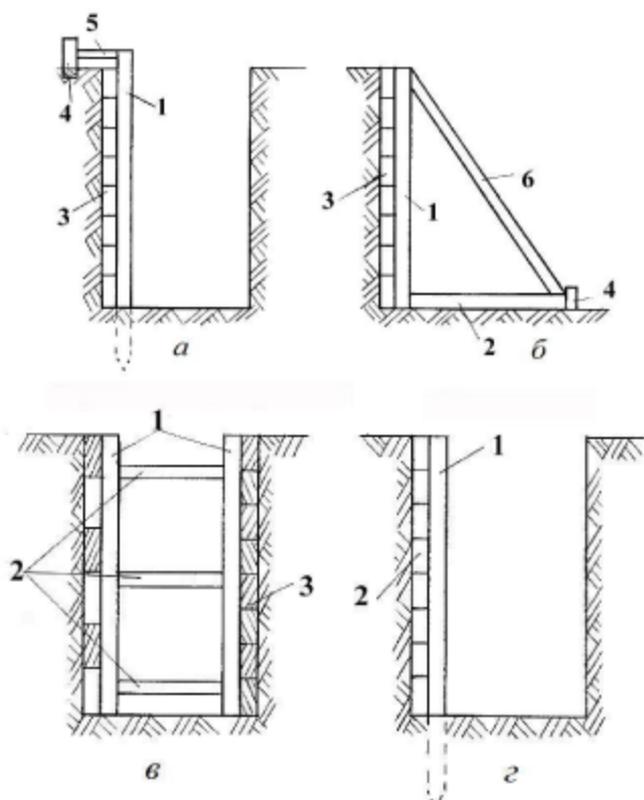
Временное крепление вертикальных стенок к выемкам:
